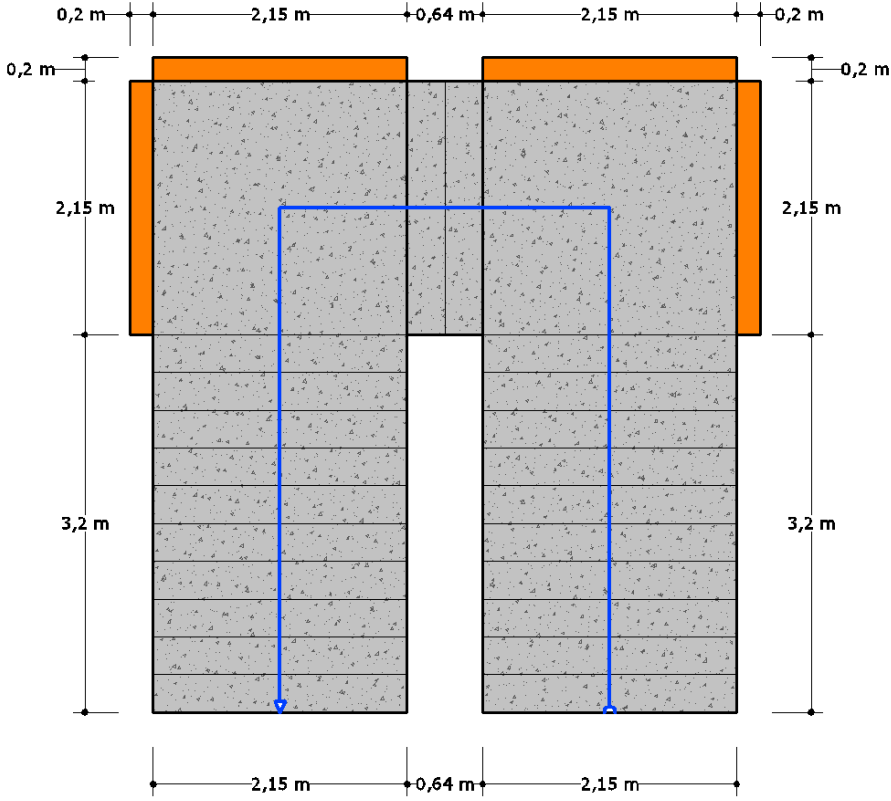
Geometria de la Escalera; Elaboracion Propia
